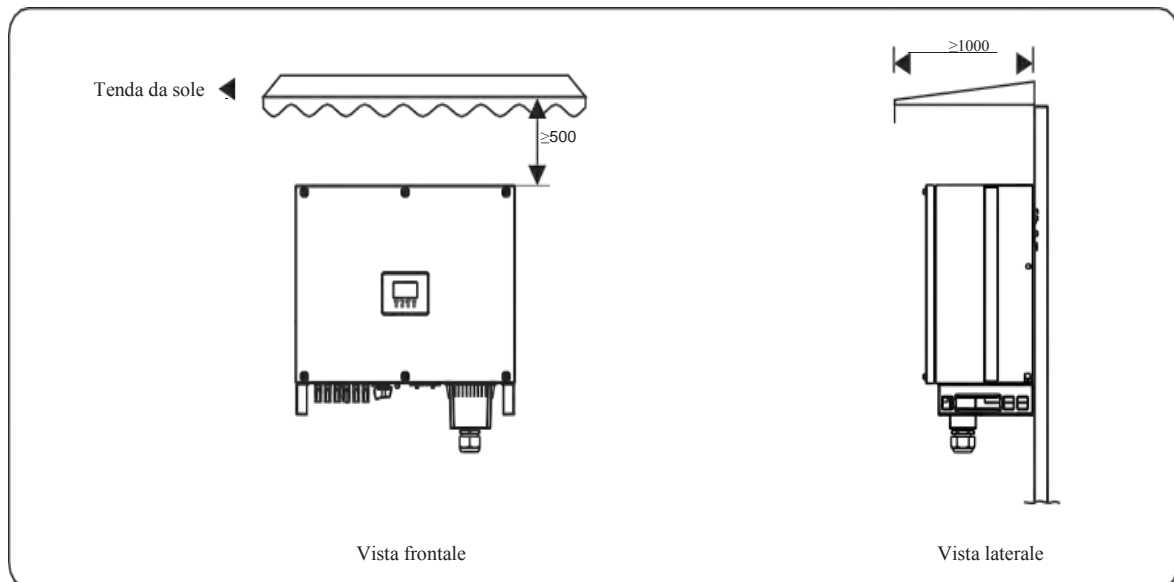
Ambiente di installazione con tenda (unità: mm)
